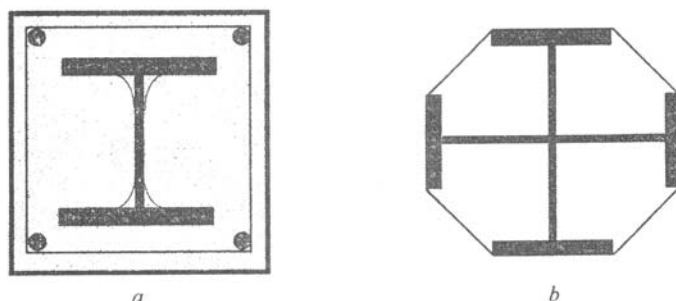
Types des sections mixtes de poteaux: *a* – profilé laminé totalement enrobé; *b* – profilé reconstitué soudé en croix Scout.
